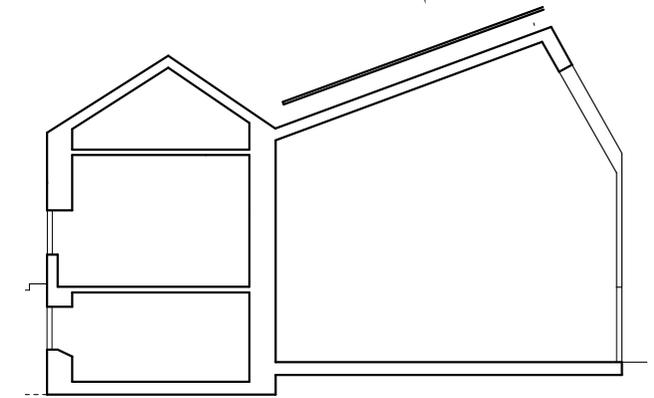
Lage thermische Kollektoren zur Warmwasserbereitung
